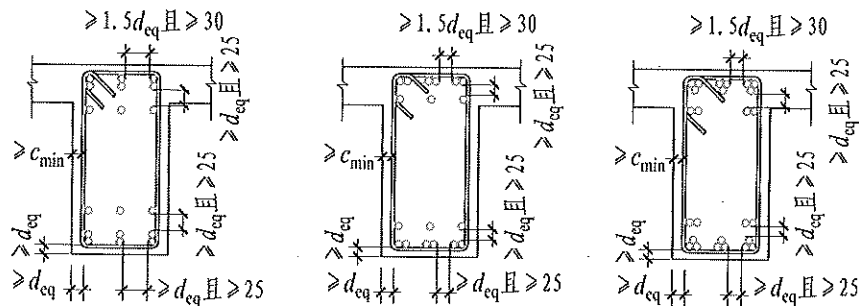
梁混凝土保护层厚度、钢筋间距要求示意图
